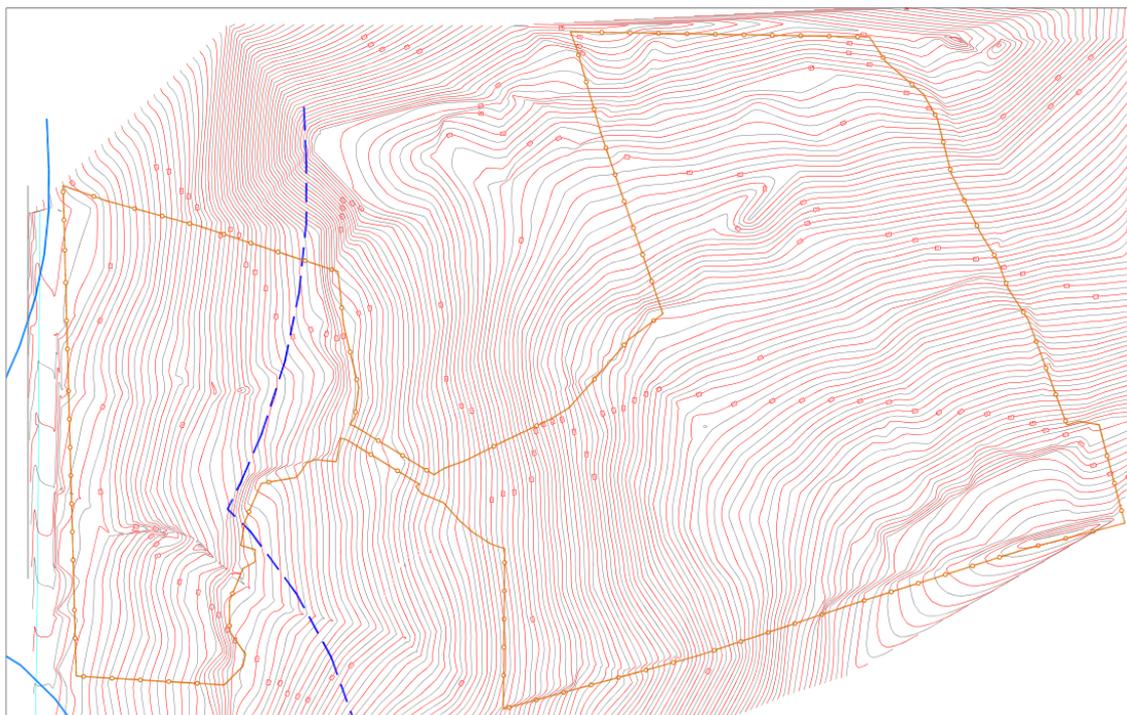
Planimetria area di intervento con indicazione limite 50 m e 150 m dal Torrente Cena
